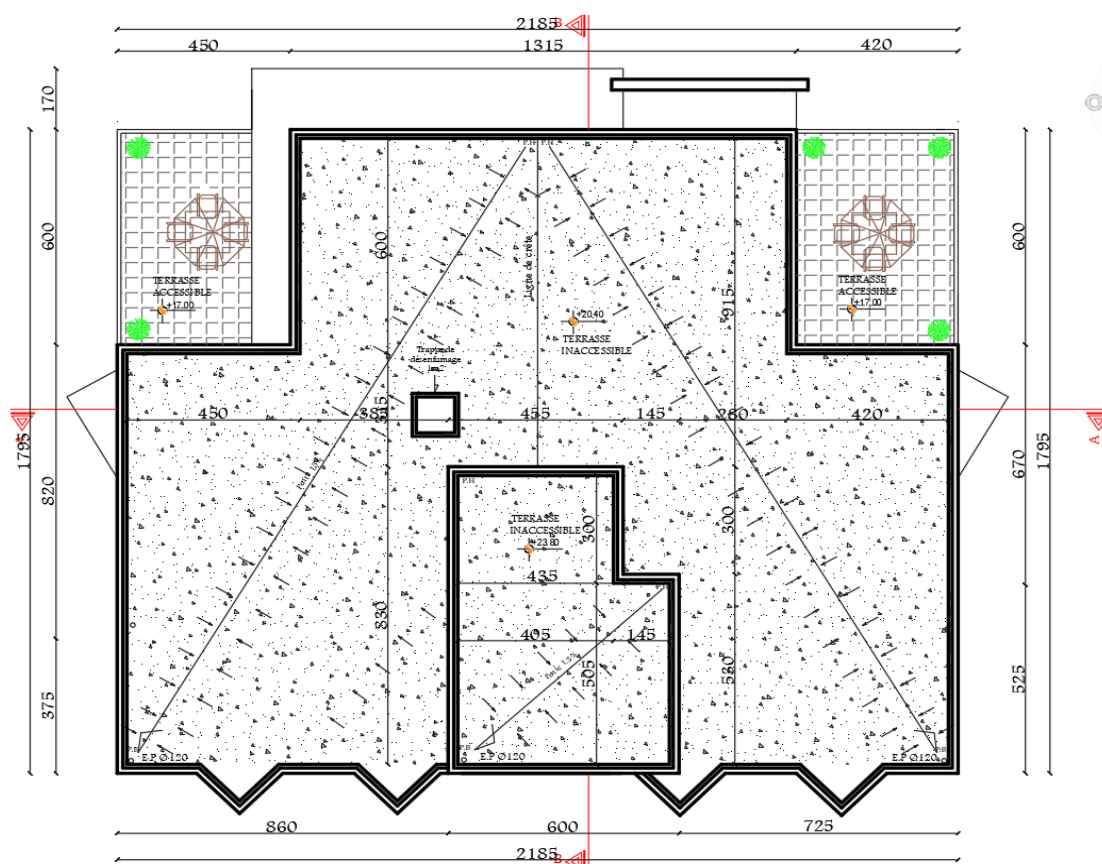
vue en plan de terrasse et niveau +20.4 de la structure
